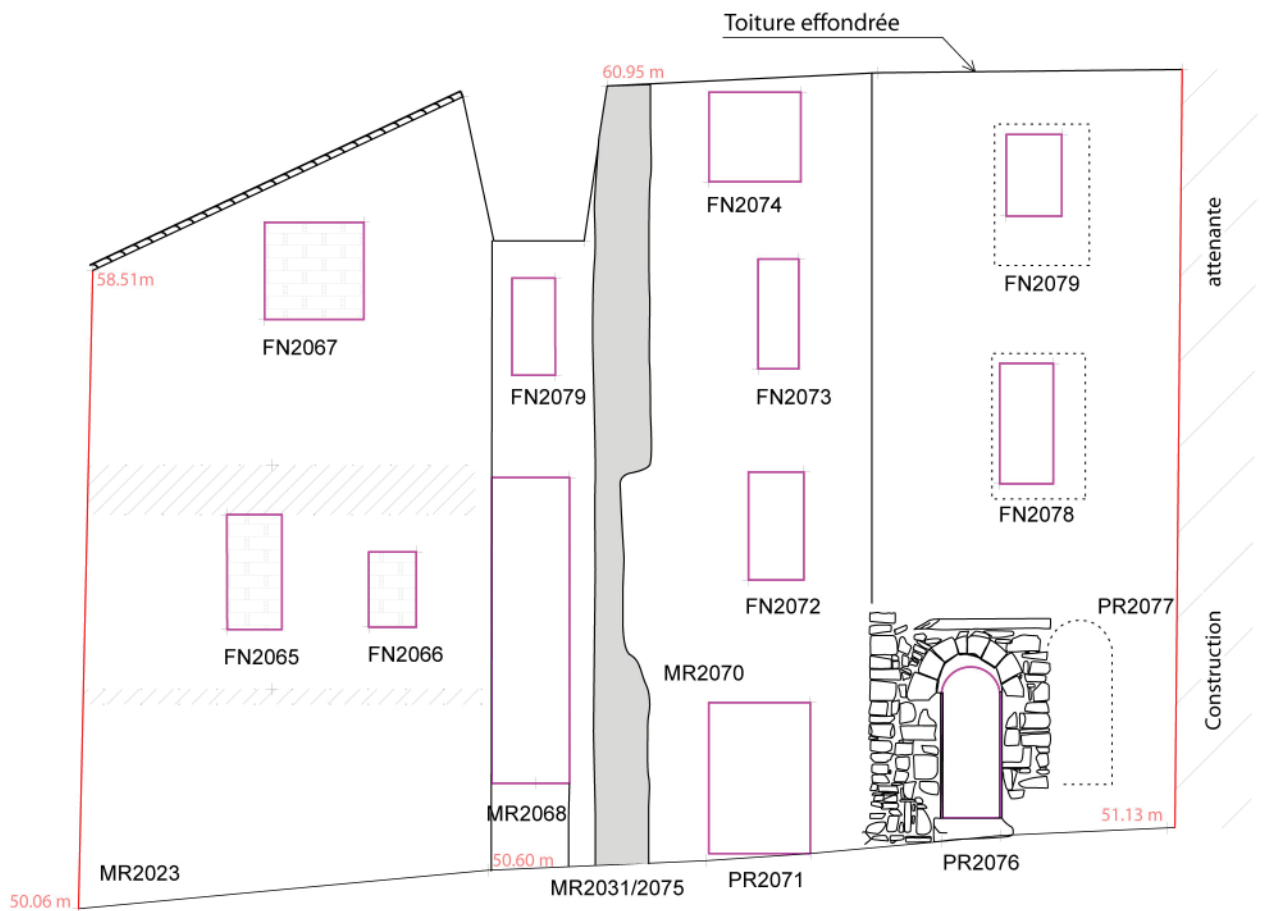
Zone 2, Façades ouest (impasse Paul Bert)
